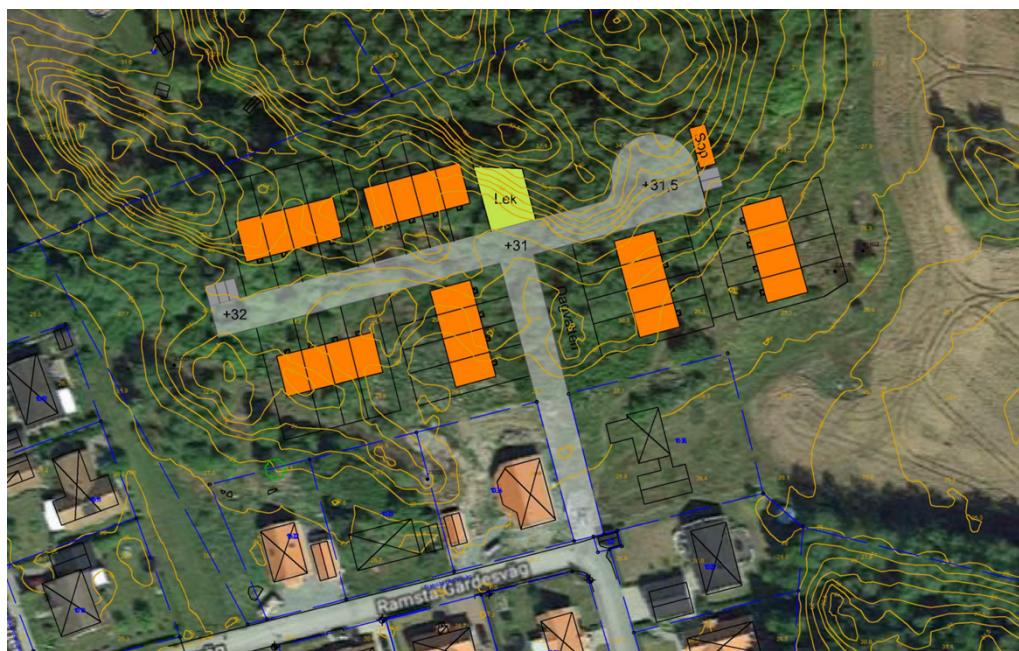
Illustrationsplan som visar förslag till utbyggnad inom planområdet. Ramböll.
